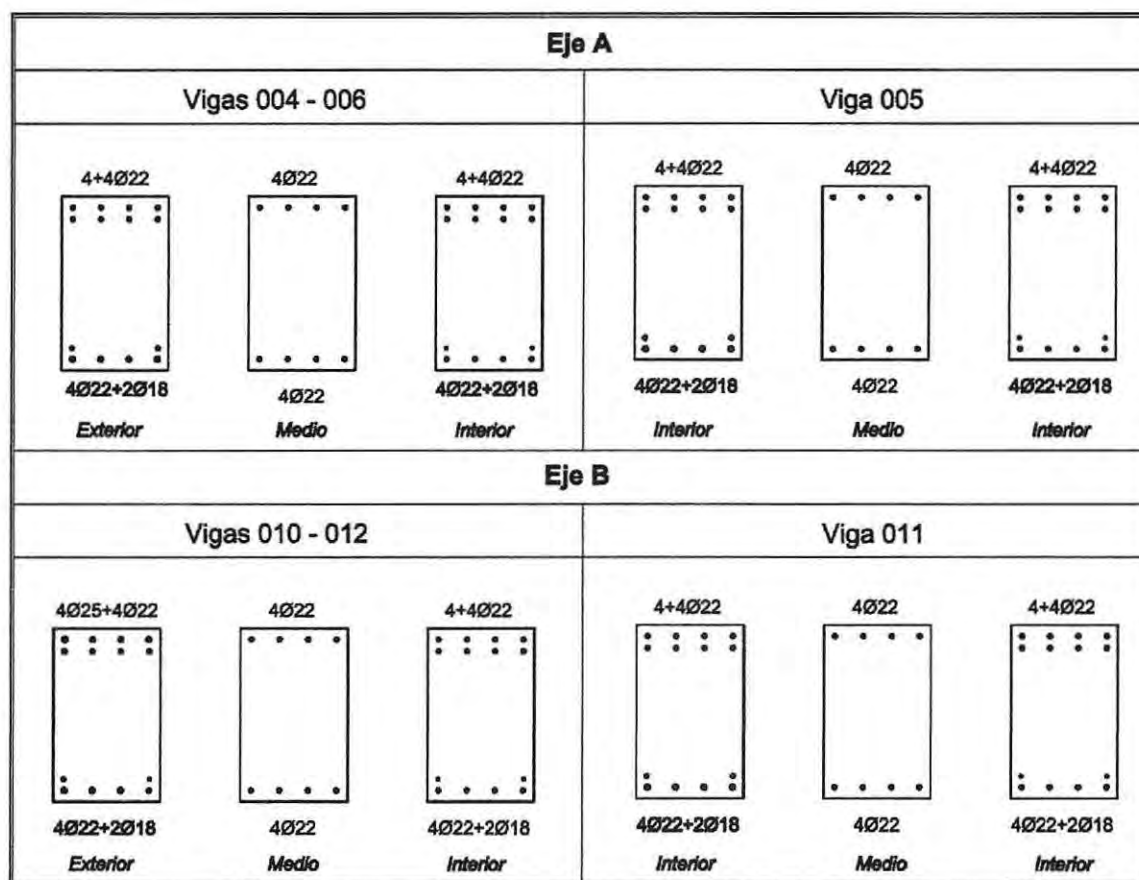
Armadura a flexión de vigas en estructura con marcos, Ejes A y B.
